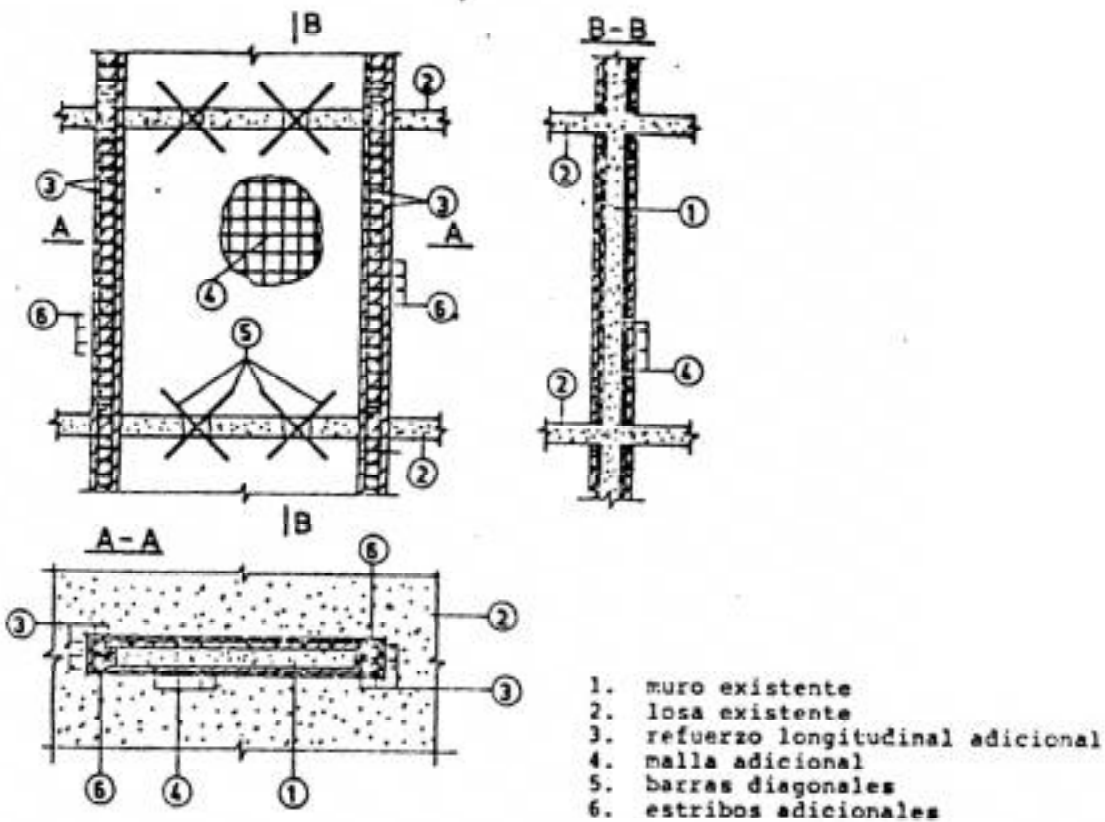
Continuidad del Refuerzo en muros de concreto (ref. 1)
